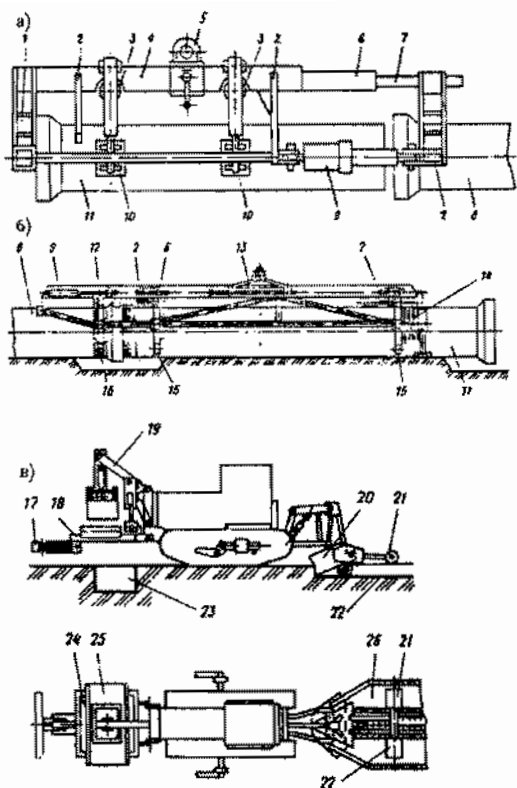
Схемы навесного устройства для монтажа железобетонных труб на резиновых уплотнительных кольцах (а), навесного оборудования для монтажа труб с раструбно-винтовым соединением (б) и граншейной машины для монтажа раструбных труб (в):
